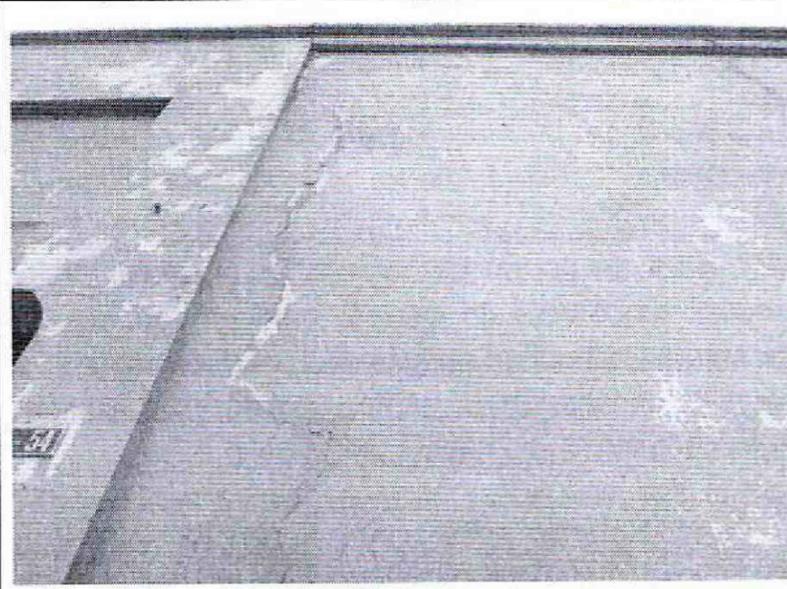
Grieta vertical al oriente del portón de entrada.
